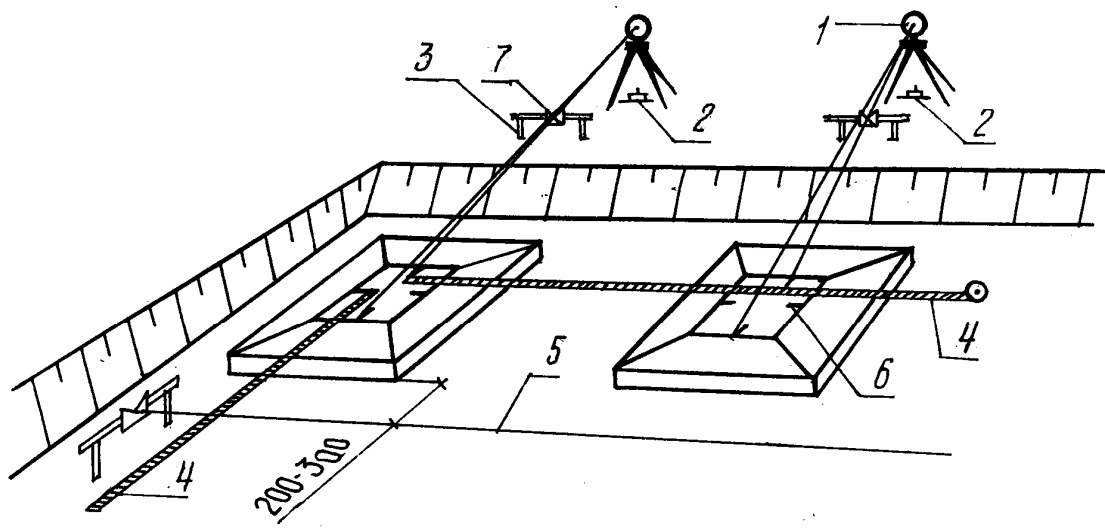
Схема перенесения осей фундамента в котлован с помощью теодолита
